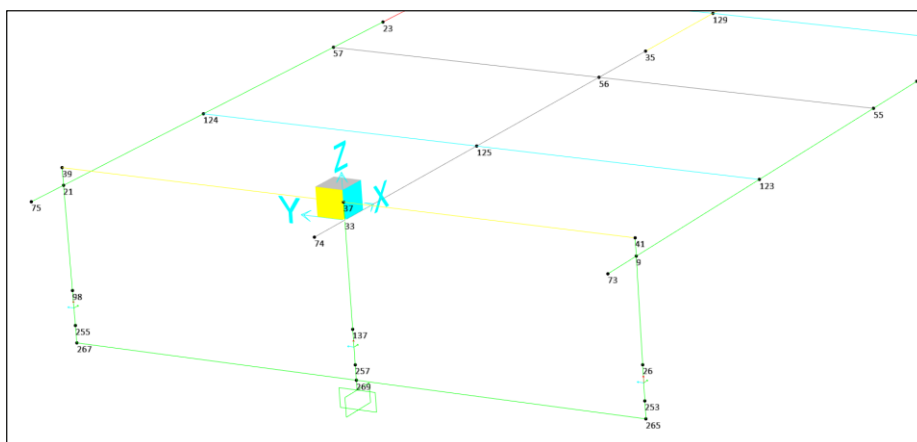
Modello dell'impalcato (schematizzazione della generica spalla)
